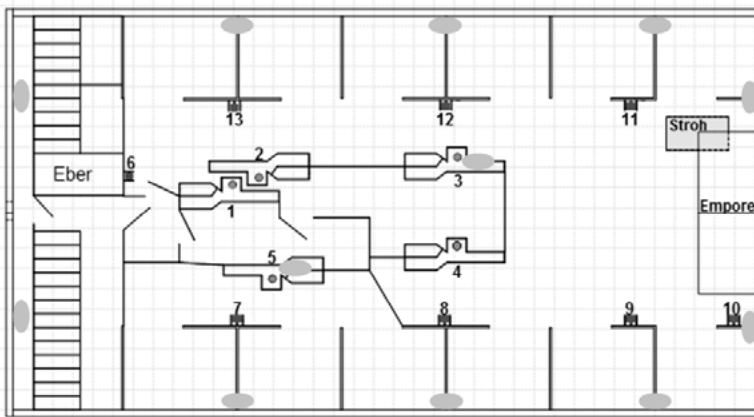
Grundriss des Wartestalls; 1–5: Abrufstationen, 6: Eberticketfenster, 7–13: Tränken
